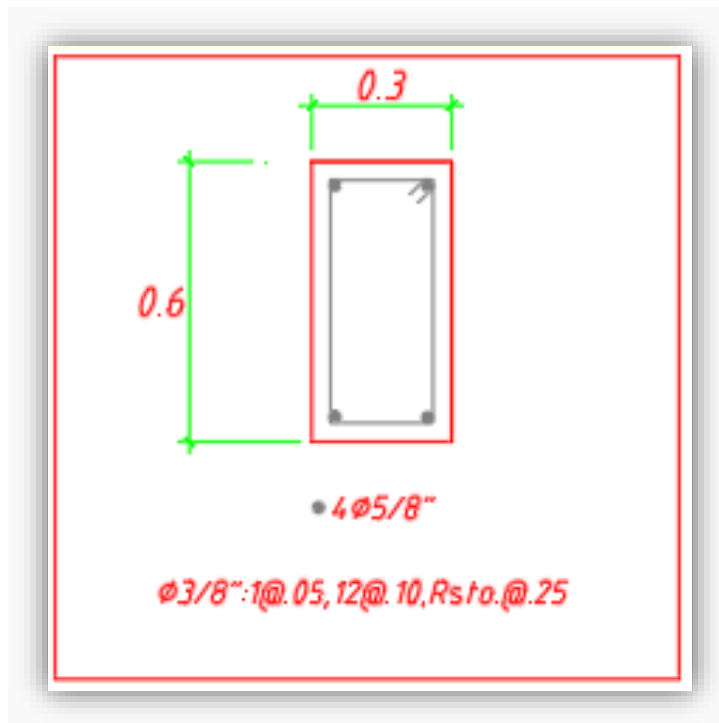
Detalle de refuerzo en vigas piso 7
